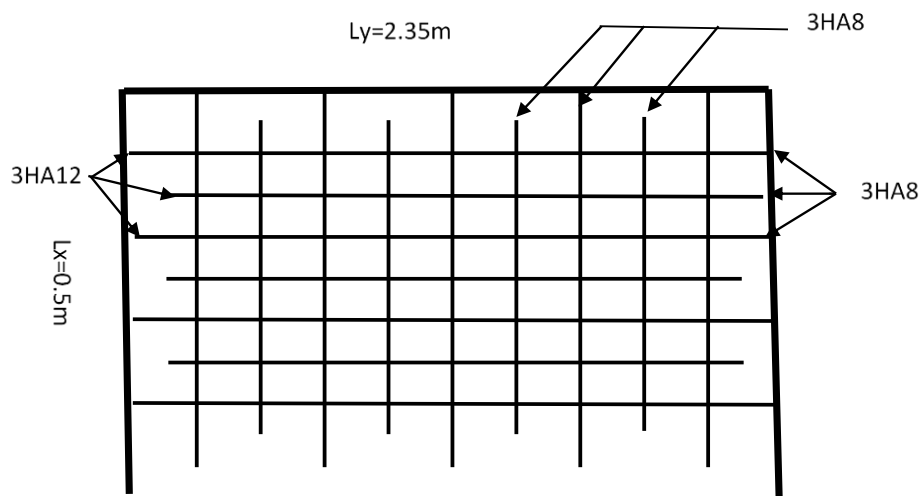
schéma de ferrailage de la dalle sur 4 appuis
